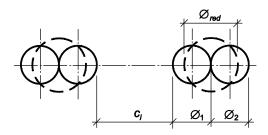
Расстояние между стержнями арматуры при ее установке в стесненных условиях
